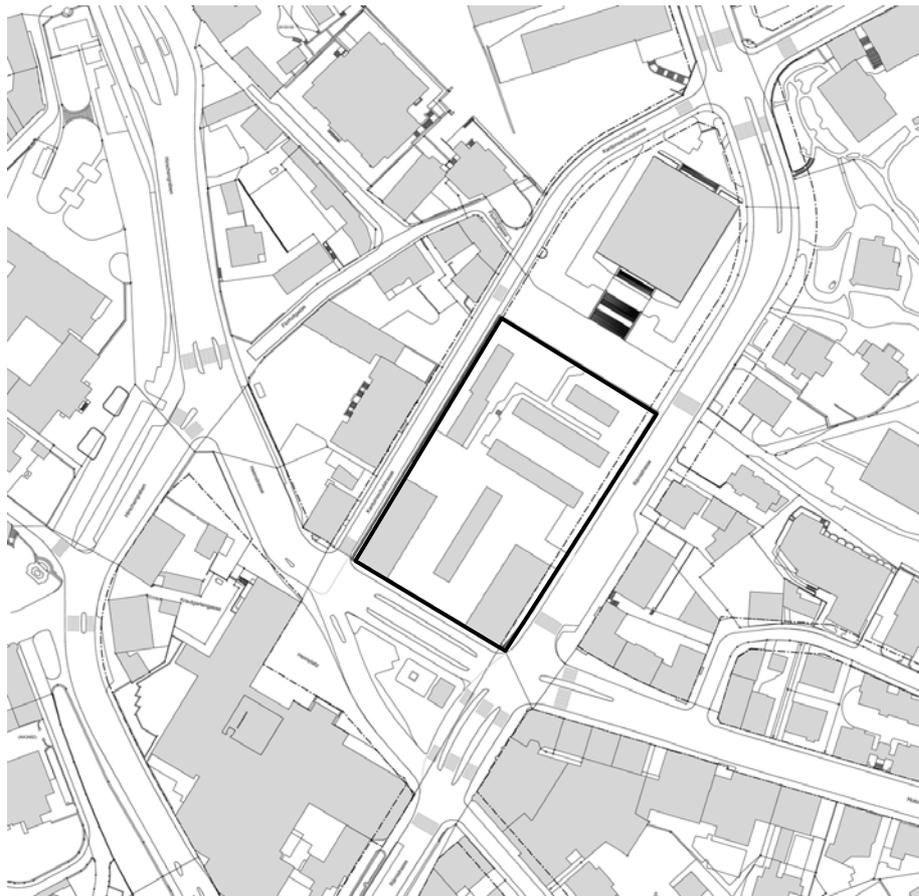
Übersichtsplan mit Perimeter „Gestaltungsplan Kunsthaus-Erweiterung“
